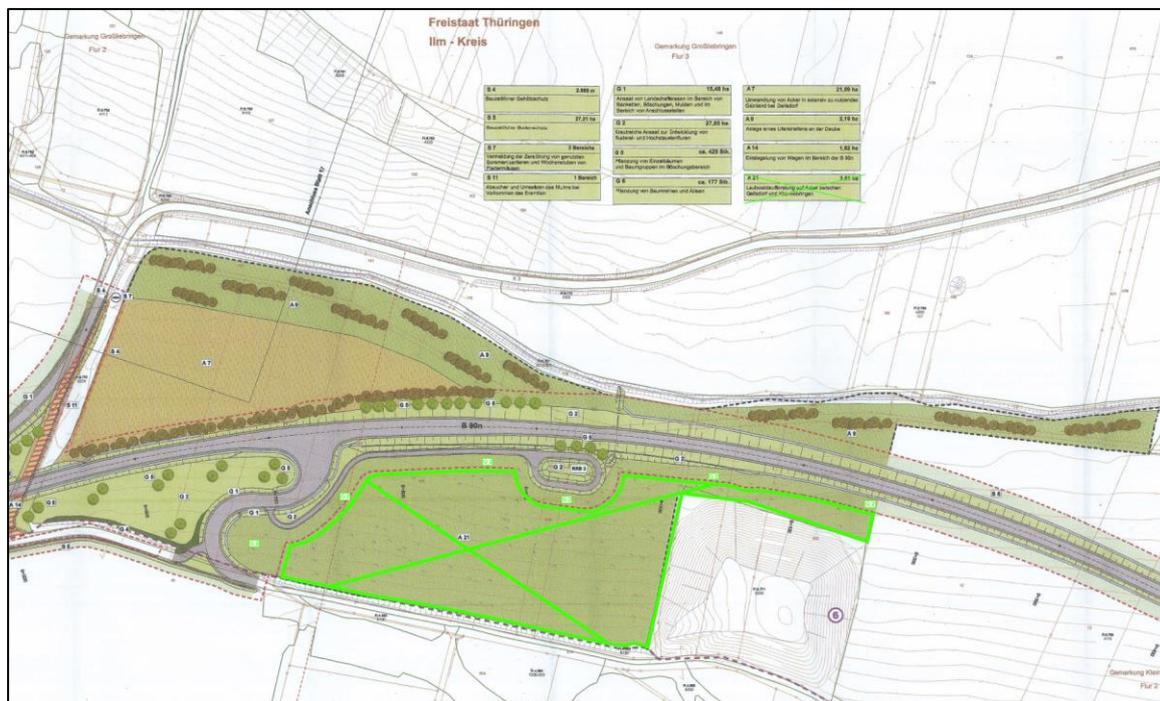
Planausschnitt Planfeststellung Traßdorf (A71) – Nahwinden (VKE 5361/62) Lageplan landschaftspflegerische Maßnahmen [15]
